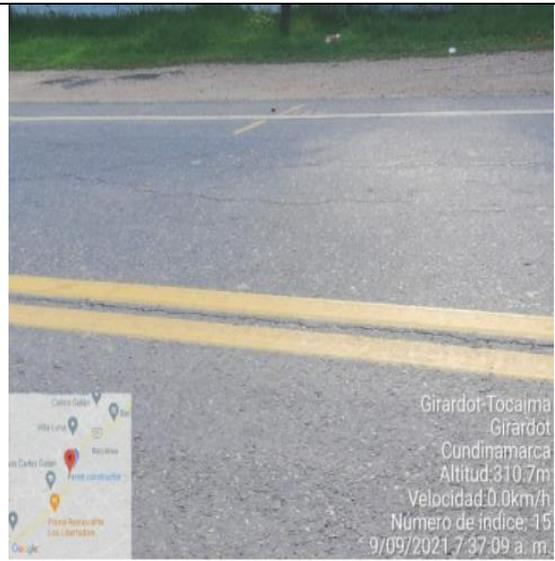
Ilustración anexo 18. Grieta longitudinal y transversal (10)
